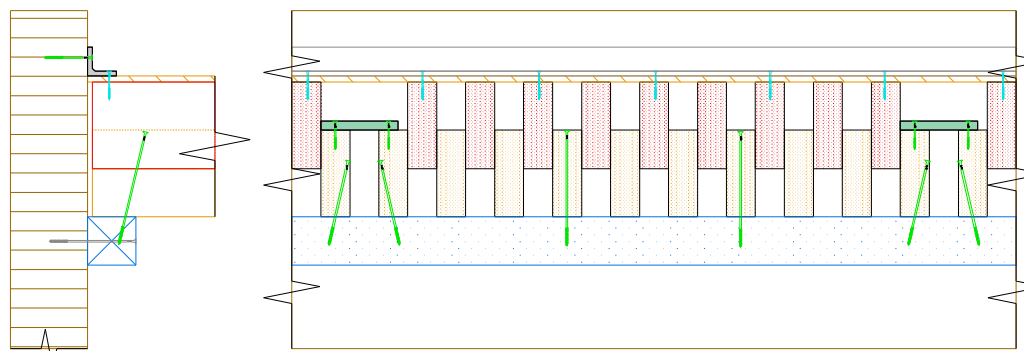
Exemple de liaison de la dalle bois à l'ossature verticale via un réseau de vis traversantes et une cornière filante
